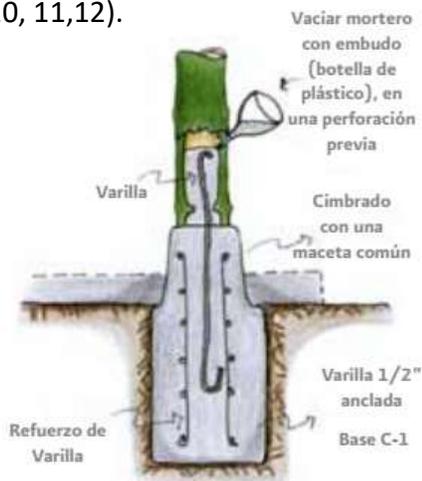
Anclaje de columnas, pies derechos. Elementos verticales a la cimentación con varilla de refuerzo.
